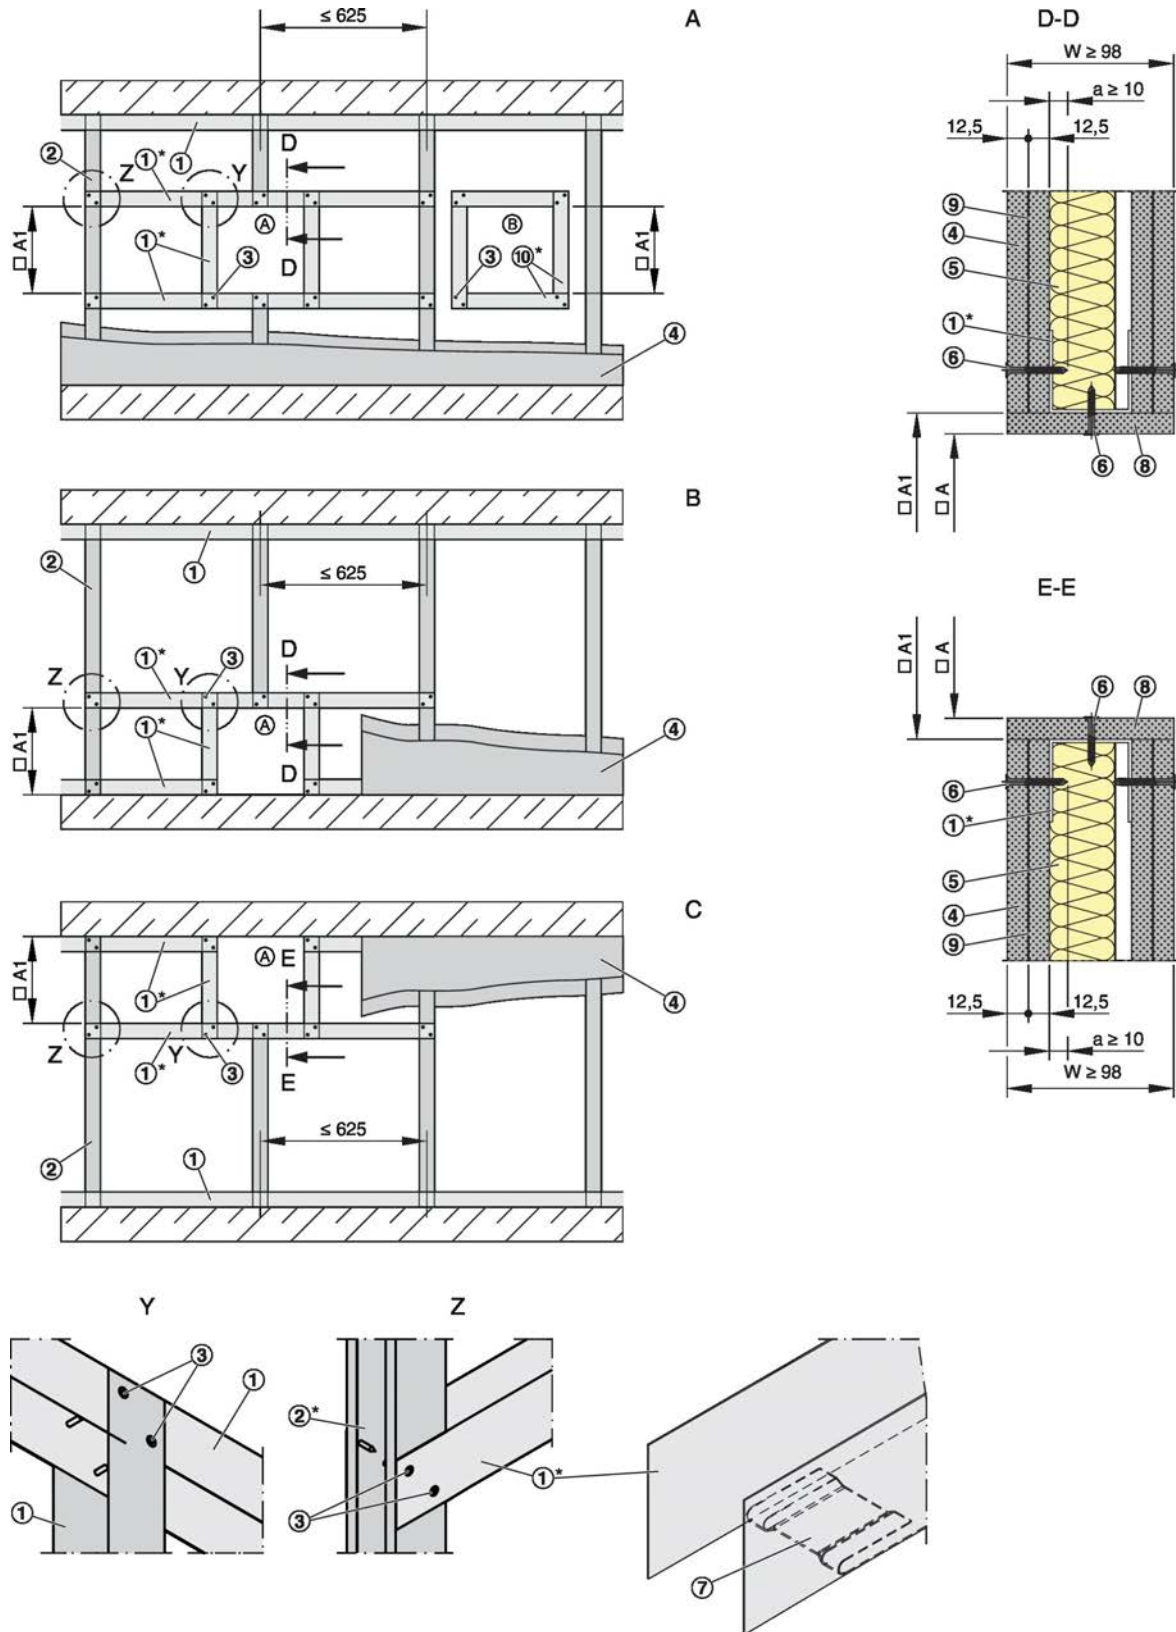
Pared ligera con estructura metálica y aislamiento a ambos lados
